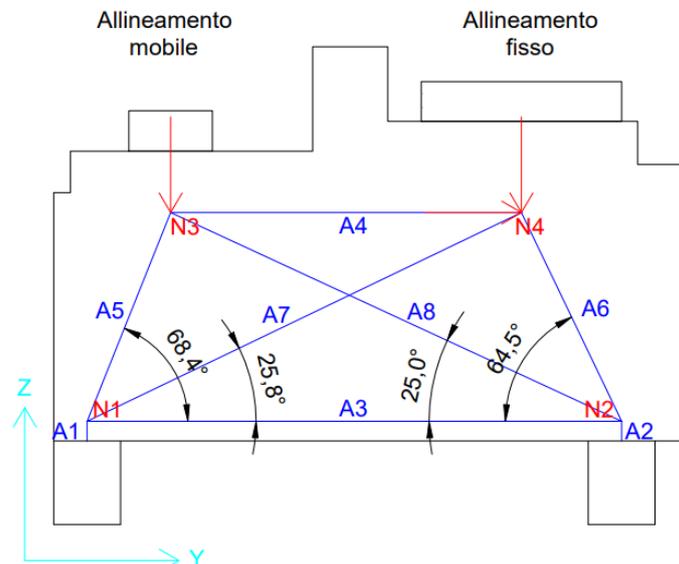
Modello a traliccio di puntoni e tiranti (direzione longitudinale)
